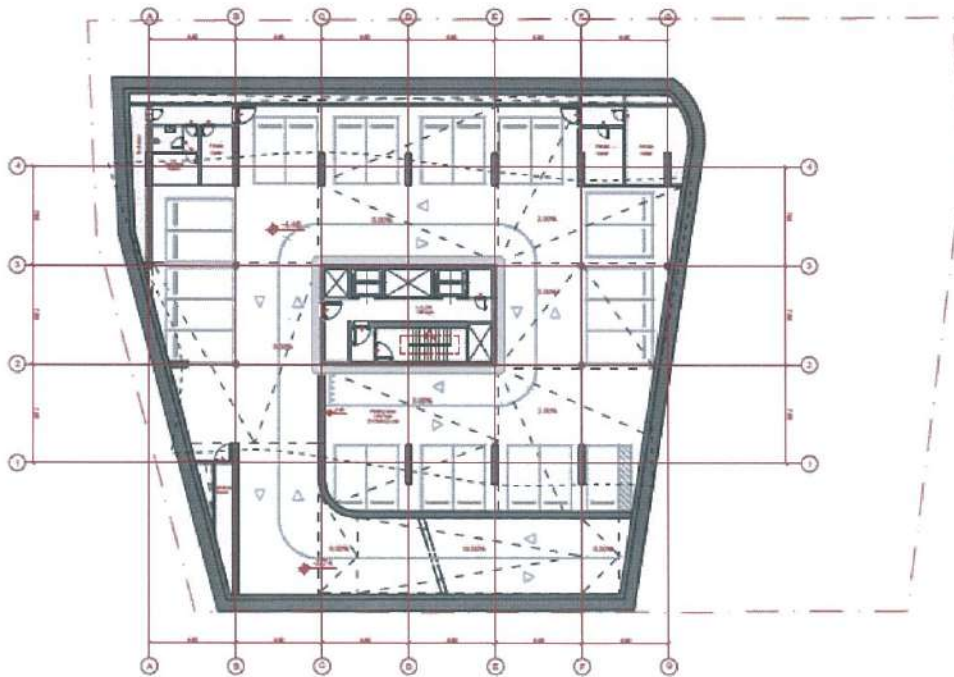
Planimetria e katit -1, në kuotën -4.46 SIP 1 515 m²
